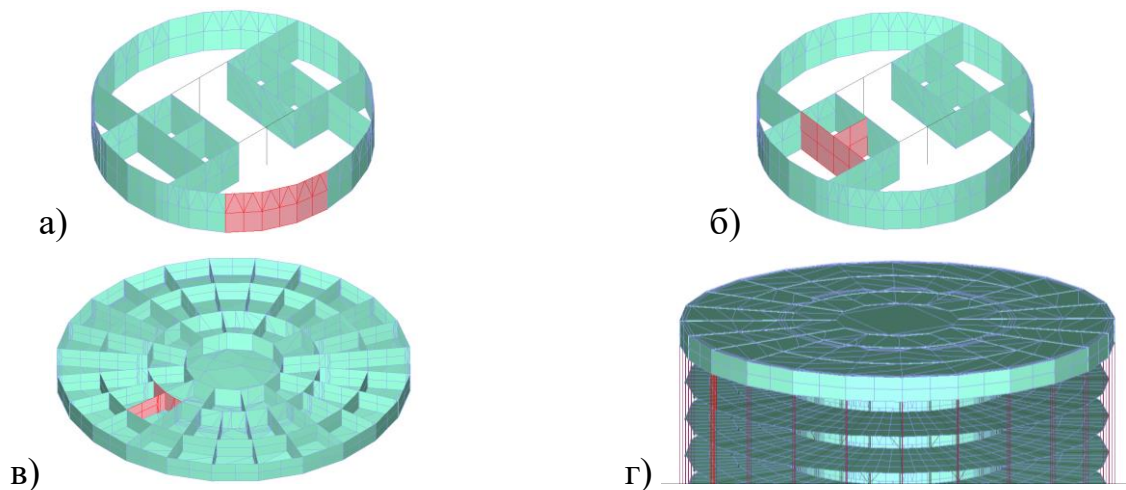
Сценарии локального разрушения несущих элементов: а) наружной стены ядра жёсткости; б) внутренних стен ядра жёсткости; в) балок консольного ростверка; г) наружных подвесок
